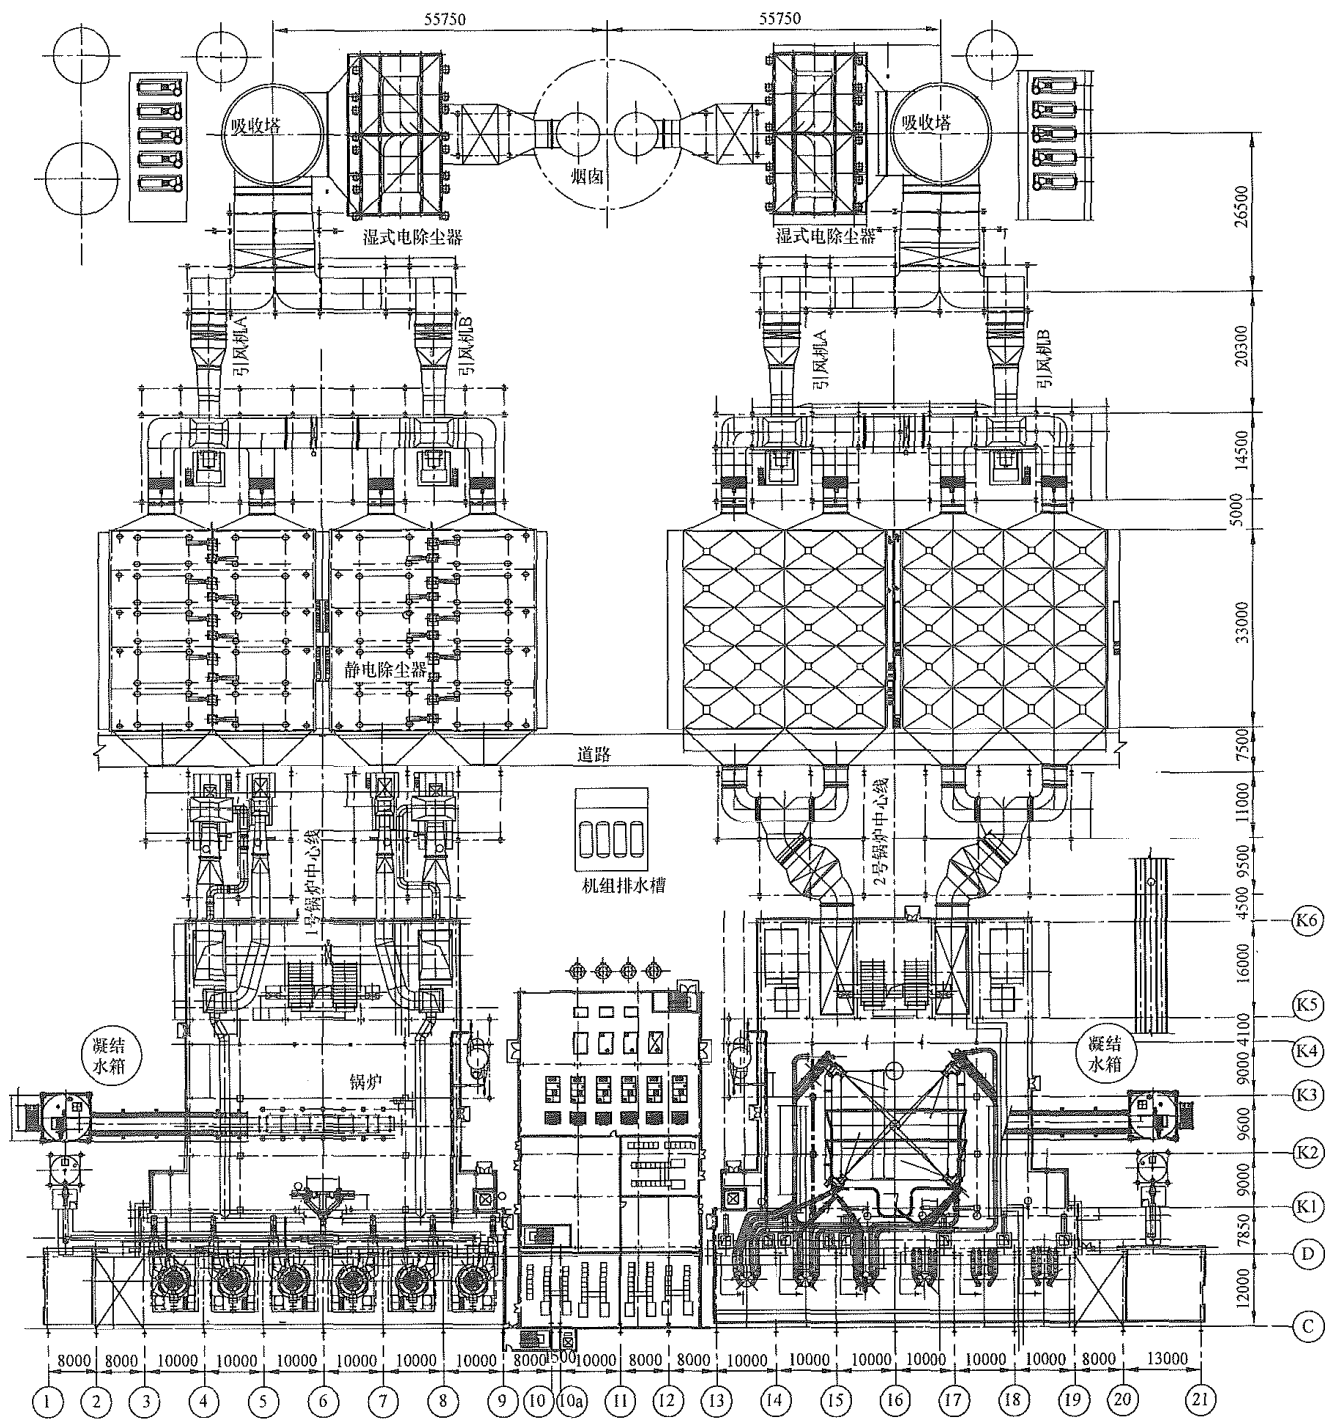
典型的 600MW 机组前煤仓锅炉岛主厂房平面布置示意图
